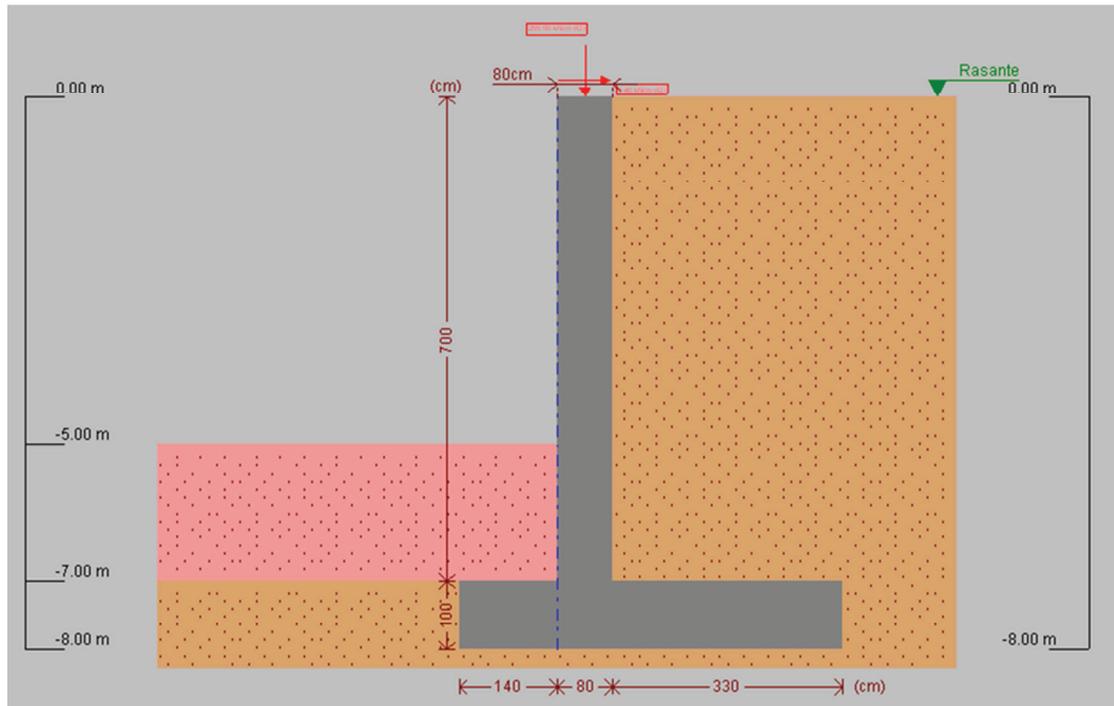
Modelo utilizado para el armado del muro y zapata (dimensiones en m)
